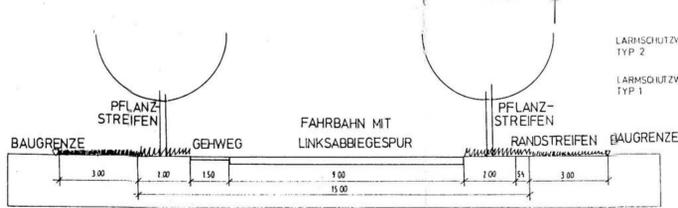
DETAIL VERKEHRSDÄMPFUNG F M.: 1:200
